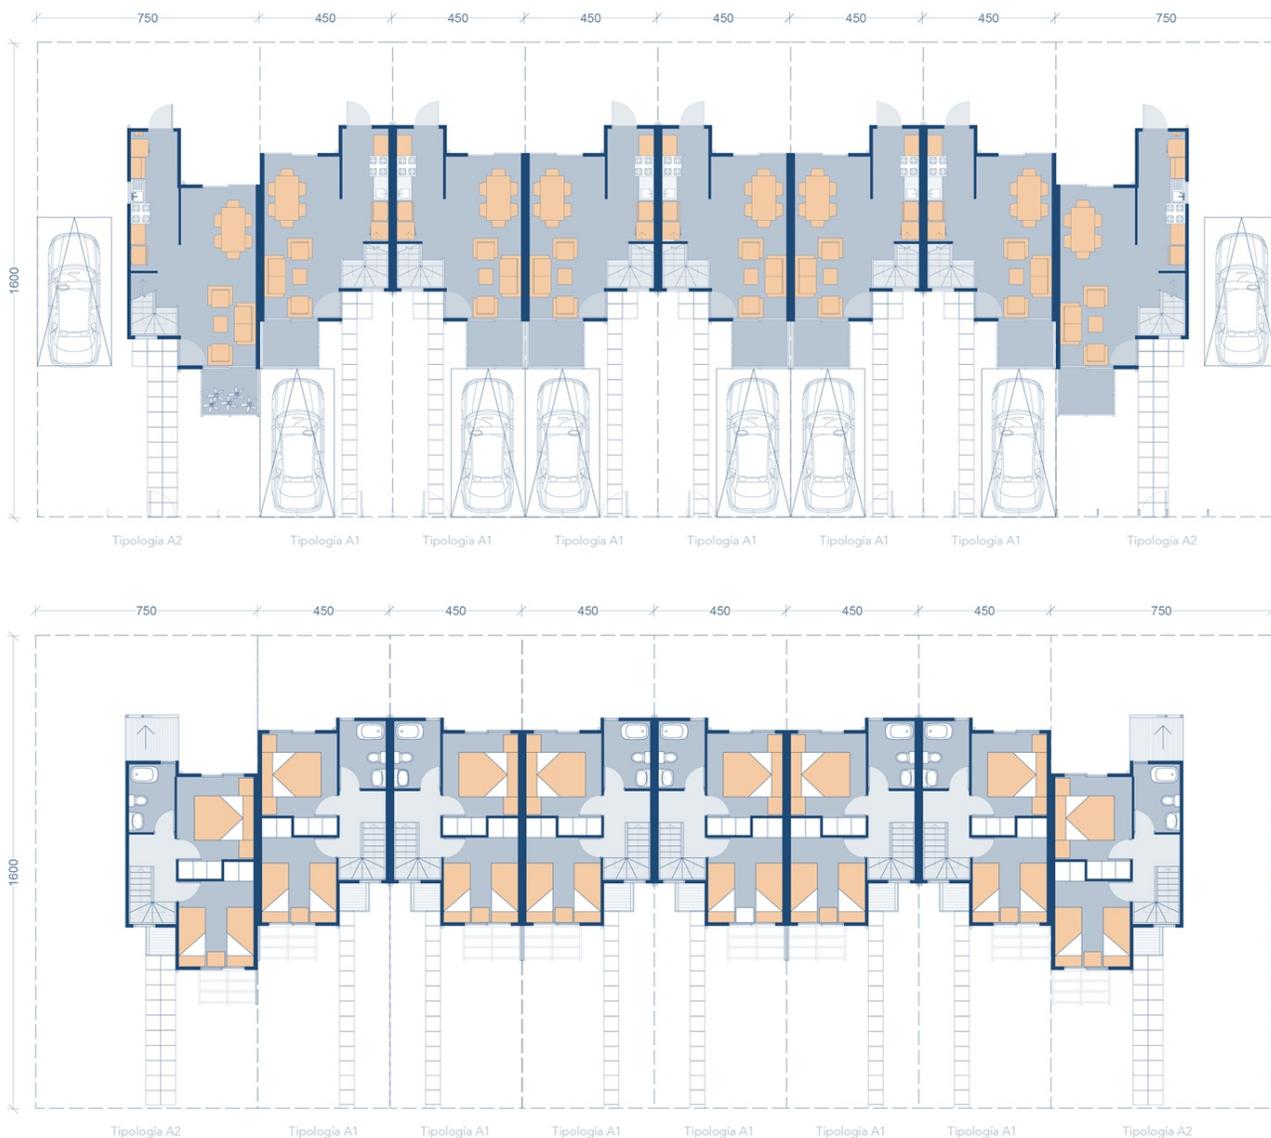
Planta primer y segundo nivel del Conjunto de viviendas adosadas de tipo A1 y A2
